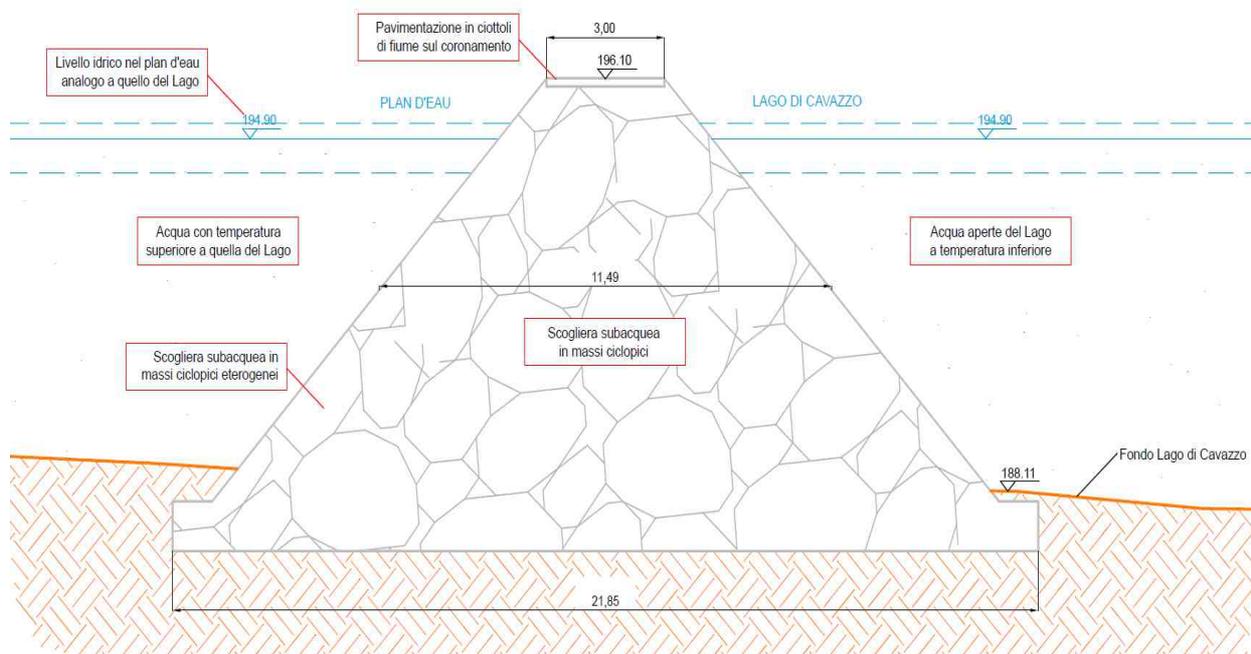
Sezione tipo della scogliera presso il plan d'eau n. 2.
